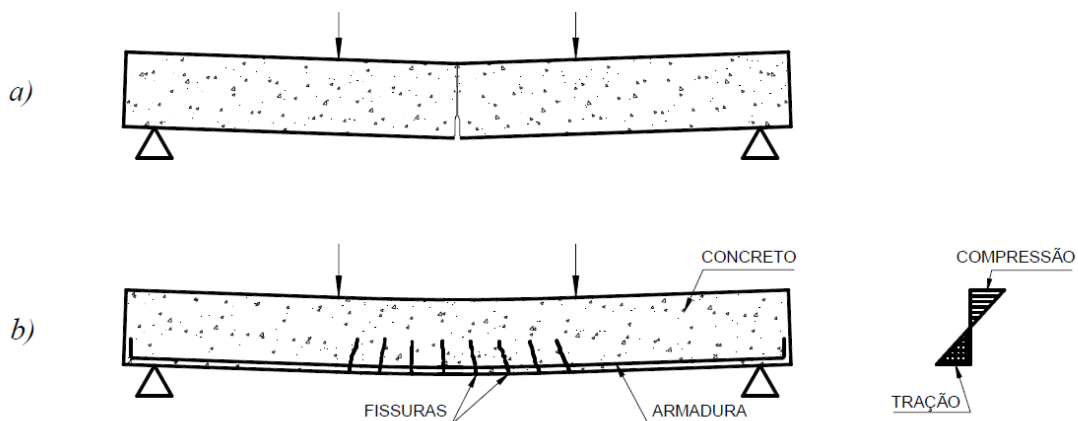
Viga de concreto simples (a) Viga de concreto armado (b)
